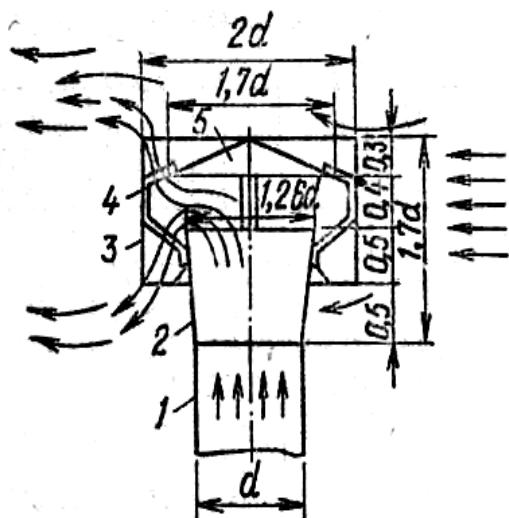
Принципиальная схема дефлектора ЦАГИ: 1 - патрубок; 2 - диффузор; 3 - корпус дефлектора; 4 - лапки для крепления зонта-колпака; 5 - зонт-колпак
